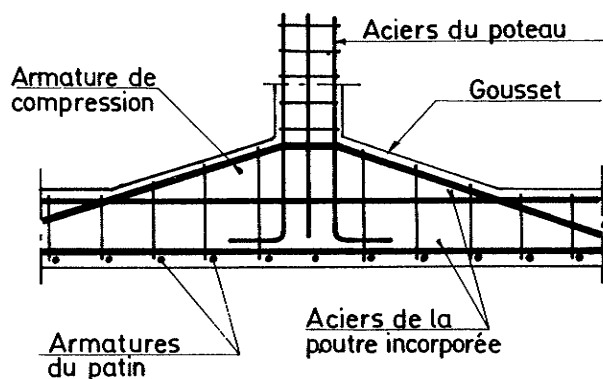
Armature d'une semelle continue sous poteaux B.A.
